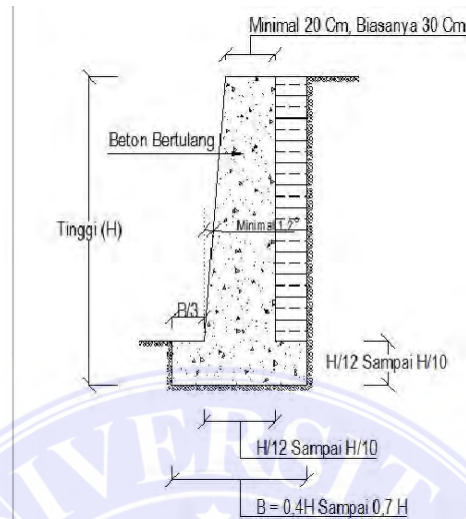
Dinding penahan tipe semi gravitasi (*semi gravity wall*).
